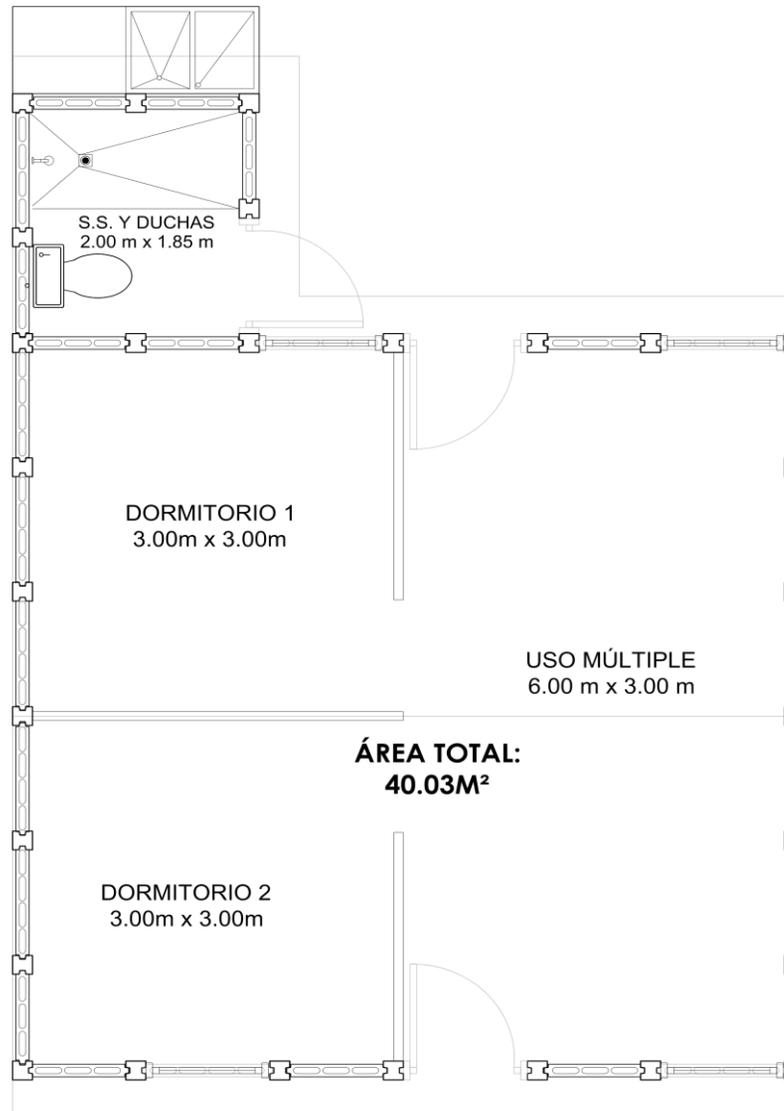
Planta tipo de vivienda de interés social de bloque panel. Fuente: FUNDASAL.
